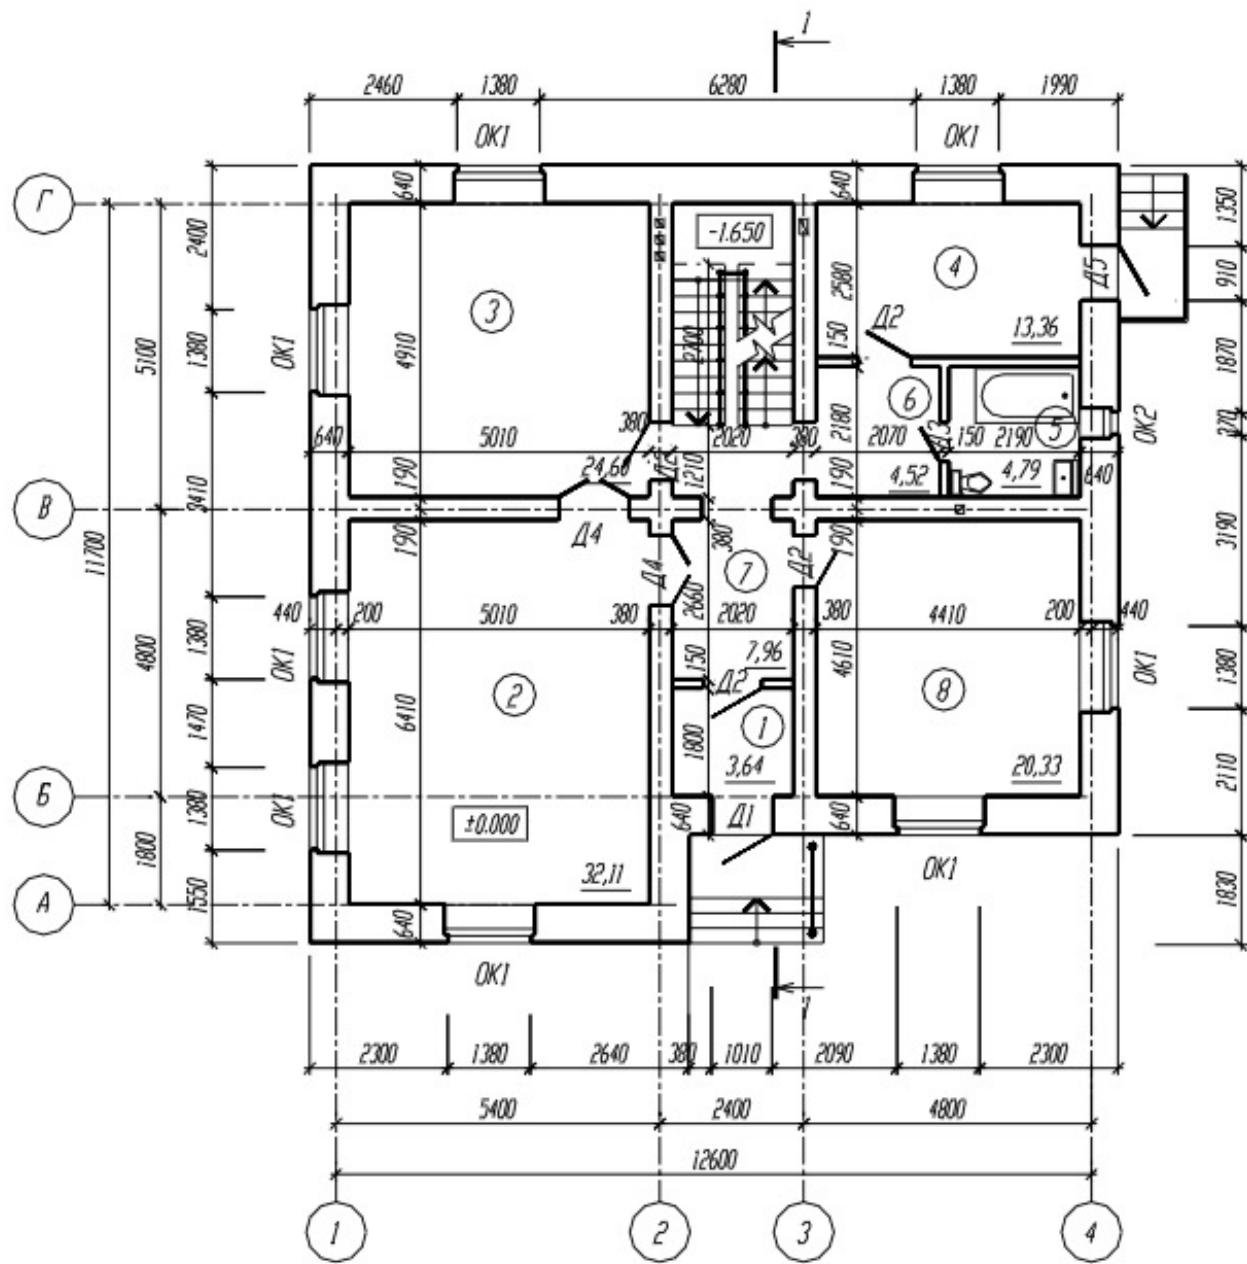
Пример оформления плана 1-го этажа жилого дома, со стенами из мелкоштучных материалов.
